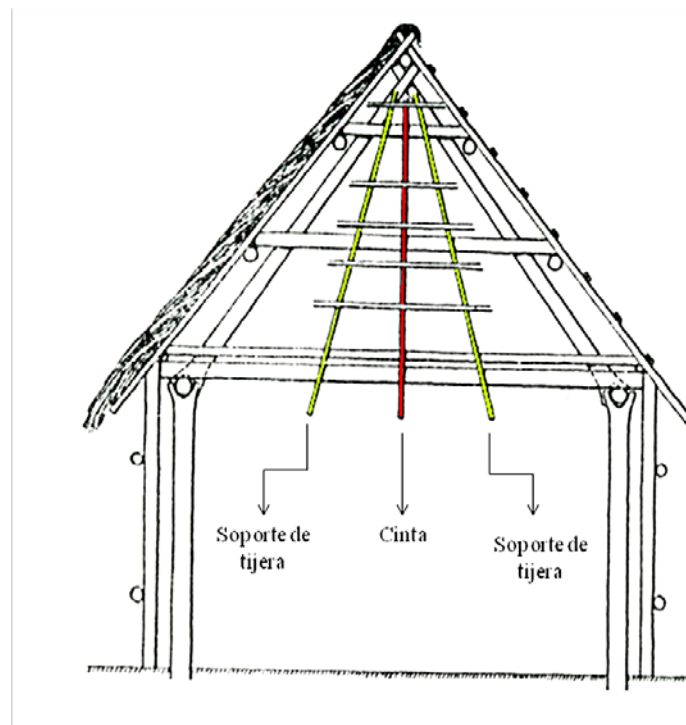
Vista de la cinta y soporte de tijeras en la estructura del techo. Tomado de Wauchope 1938: figura 32.
